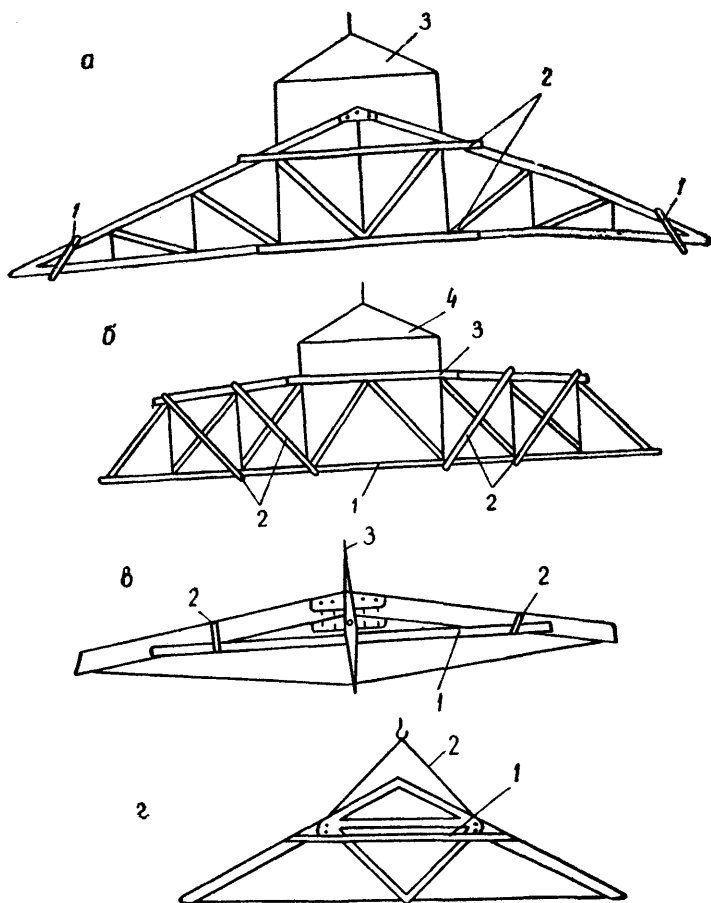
Временные монтажные крепления конструкции при монтаже: а — треугольная ферма на лобовых врубках: 1 — расшивка на гвоздях; 2 — монтажные парные схватки из брусьев; 3 — траверса; б — пятиугольная ферма на лобовых врубках: 1 — крепление нижнего пояса; 2 — парные расшивки на гвоздях; 3 — распорка; 4 — траверса; в — монтажные крепления при монтаже шпренгельной фермы: 1 — парные монтажные бревна или брусья на скрутке; 2 — скрутка из арматурной стали; 3 — строп; г — монтажные крепления при подъеме металло-деревянной фермы: 1 — парная схватка-распорка; 2 — строп.
